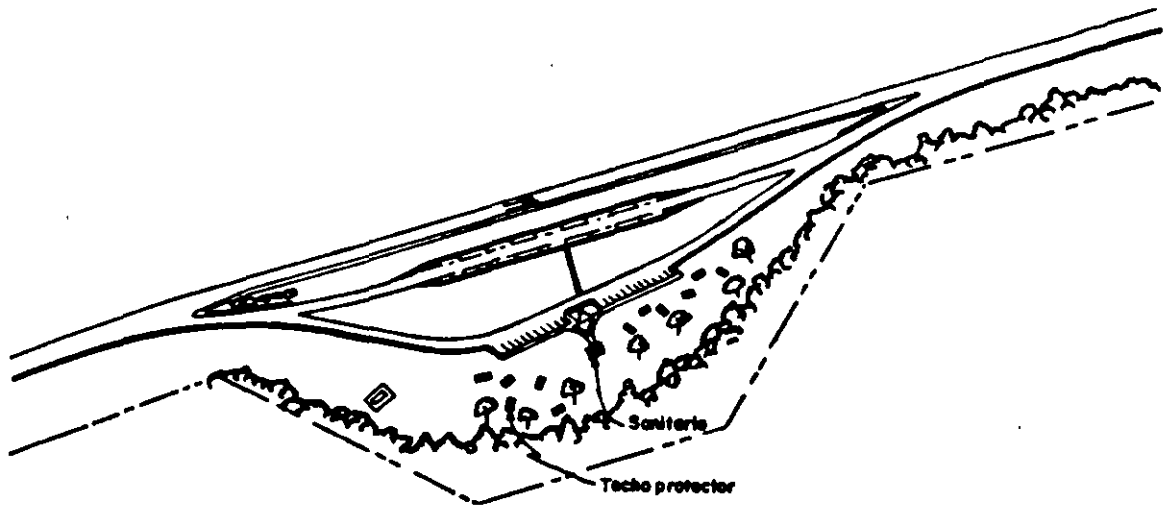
ZONA DE DESCANSO CON DOS AREAS SEPARADAS DE ESTACIONAMIENTO, UNA PARA AUTOMOVILES Y OTRA PARA CAMIONES
